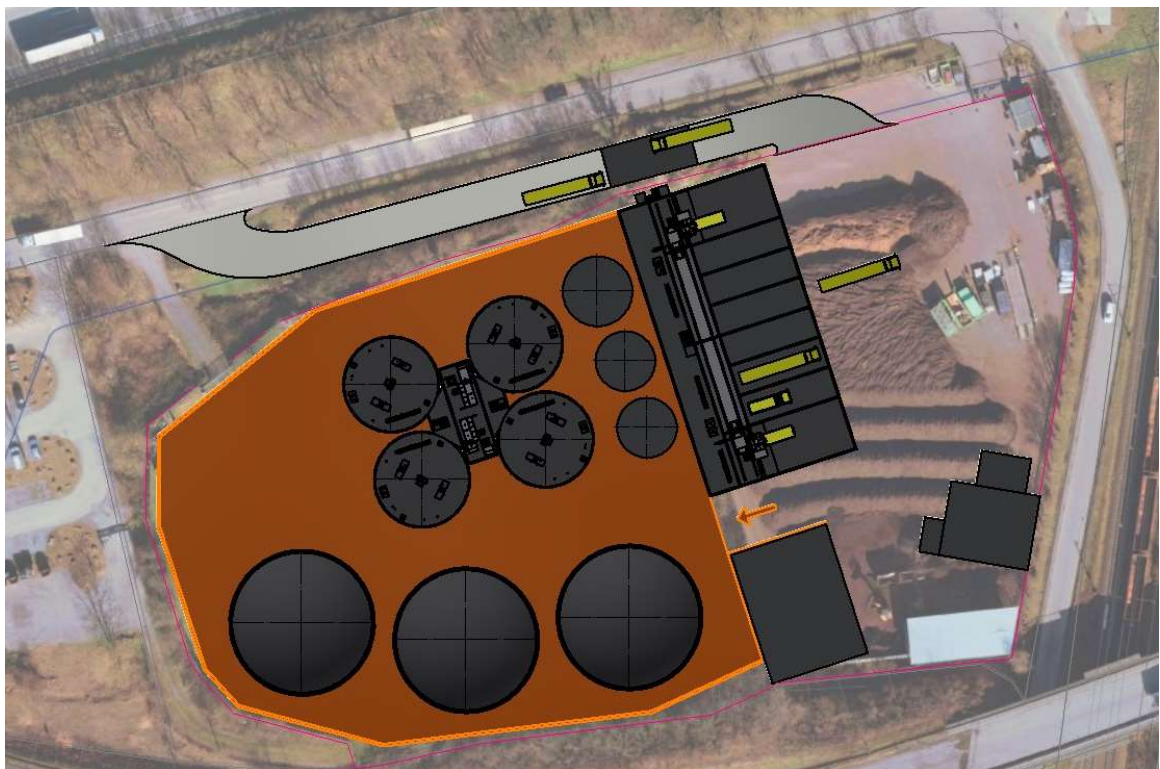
Luftbild mit Lageplan der Bioabfallvergärungsanlage (Quelle: Finsterwalder Umweltechnik)
